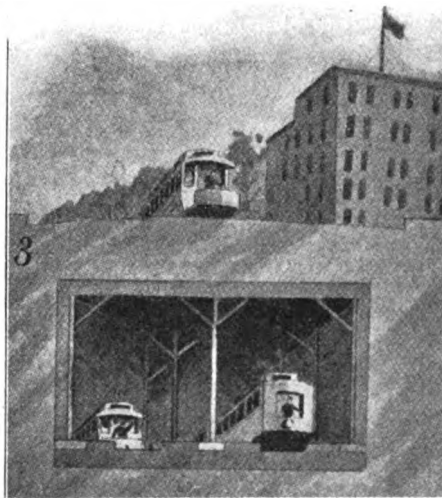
Tunnelbau mit Trägerkonstruktion unter der Lenox Avenue.
